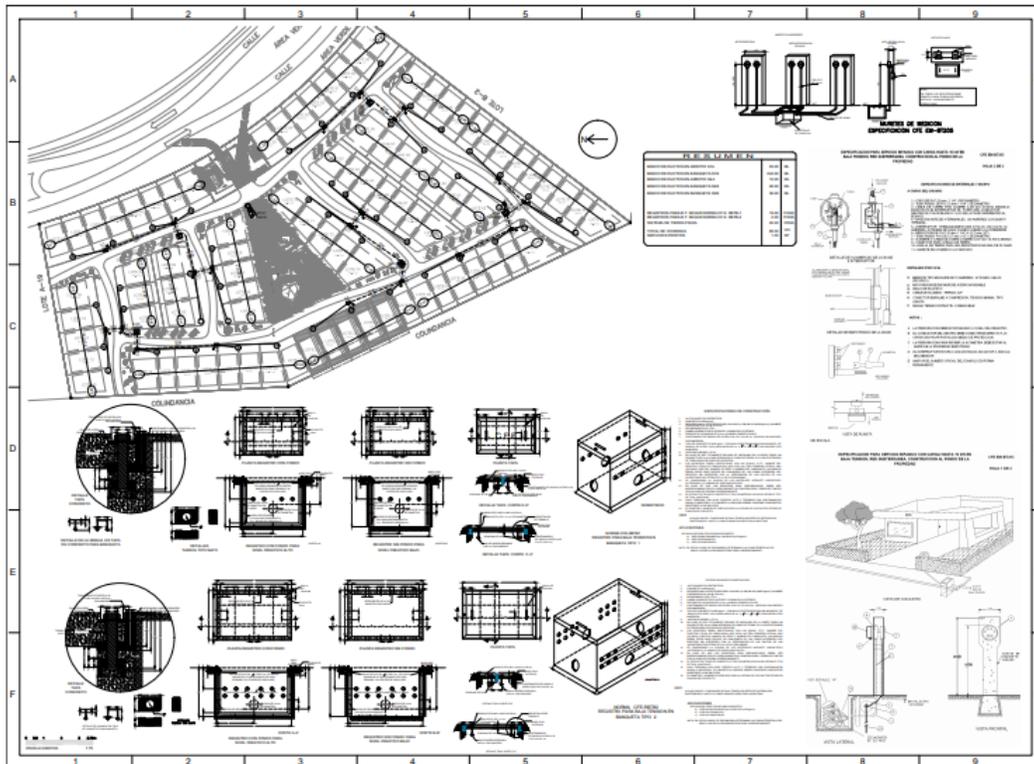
Plano de instalaciones eléctricas y detalles arquitectónicos.
